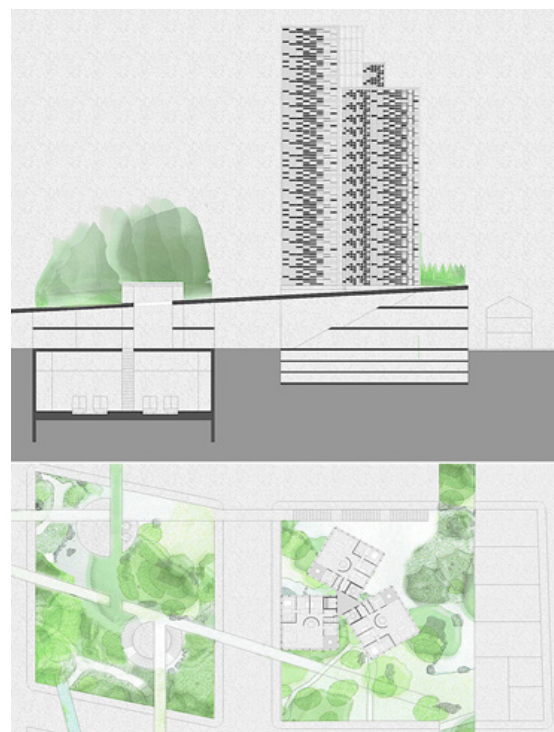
Planta y sección de la estación y plataforma final de Blasco Ibáñez.
